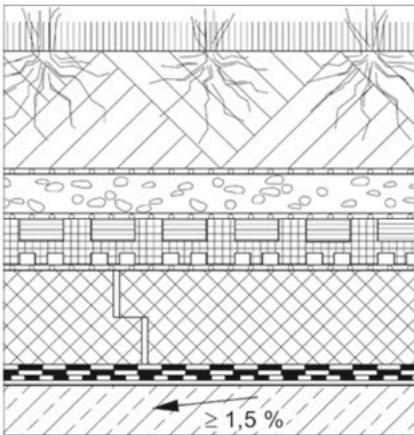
Typischer Dachaufbau mit Extensivbegrünung [14]
